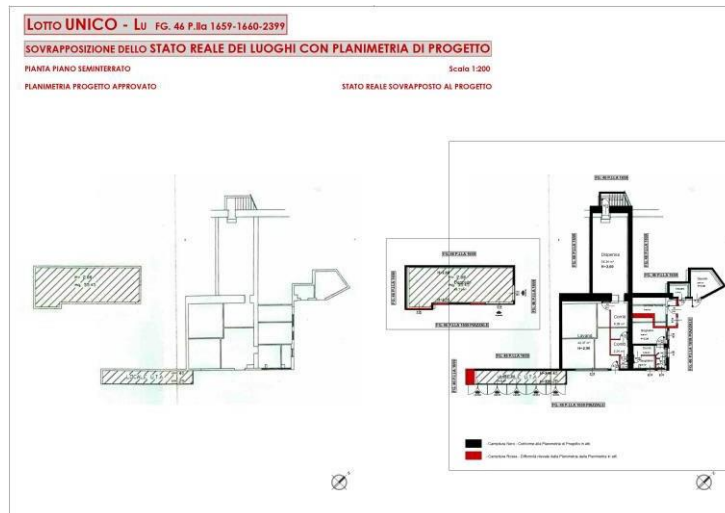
Raffronto stato reale con planimetria di Progetto LOTTO LU – P. S (ALL. 08).
